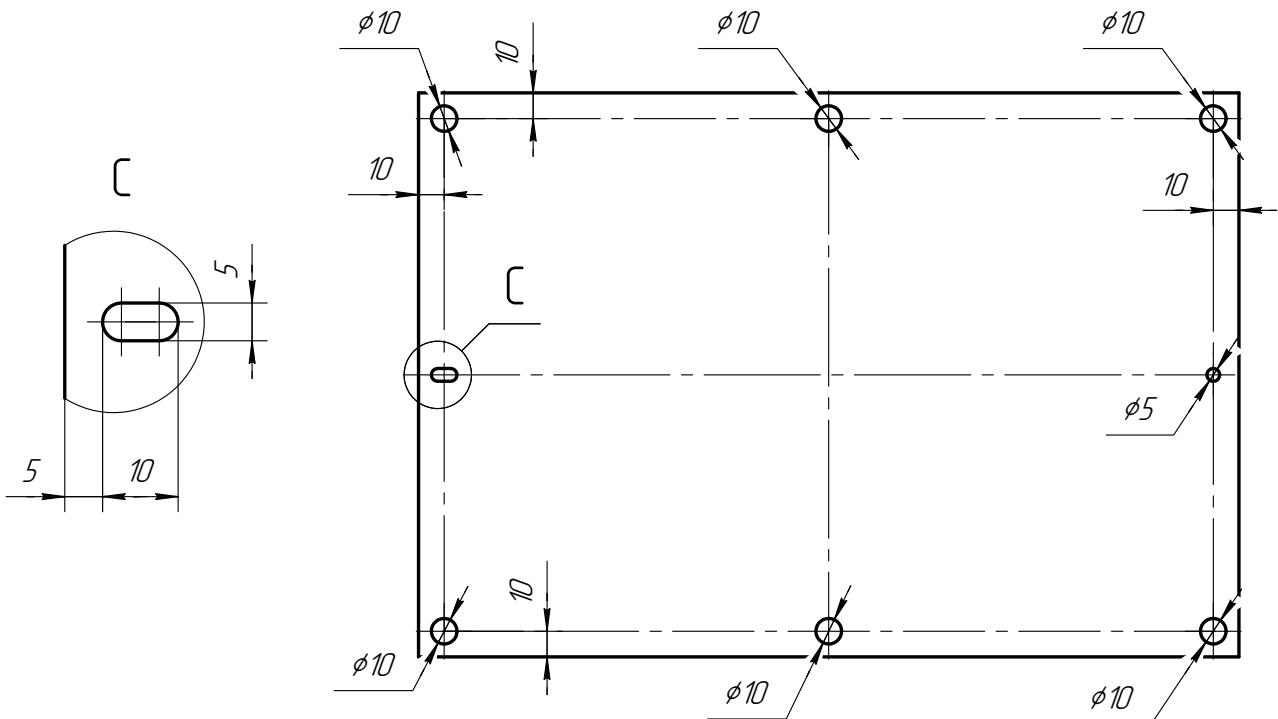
Пазы для горизонтальных фасадных панелей
